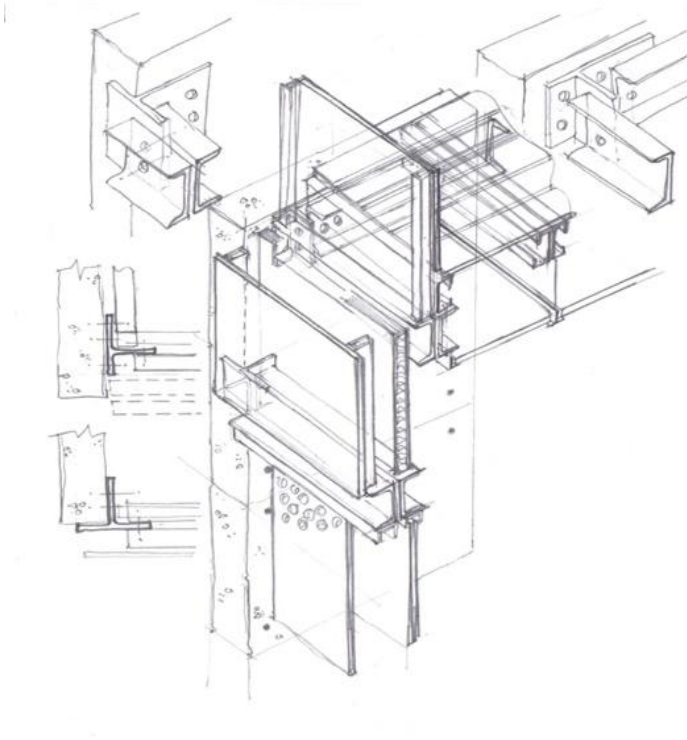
Dibujo para detalle constructivo de Jesús Guardiola.
